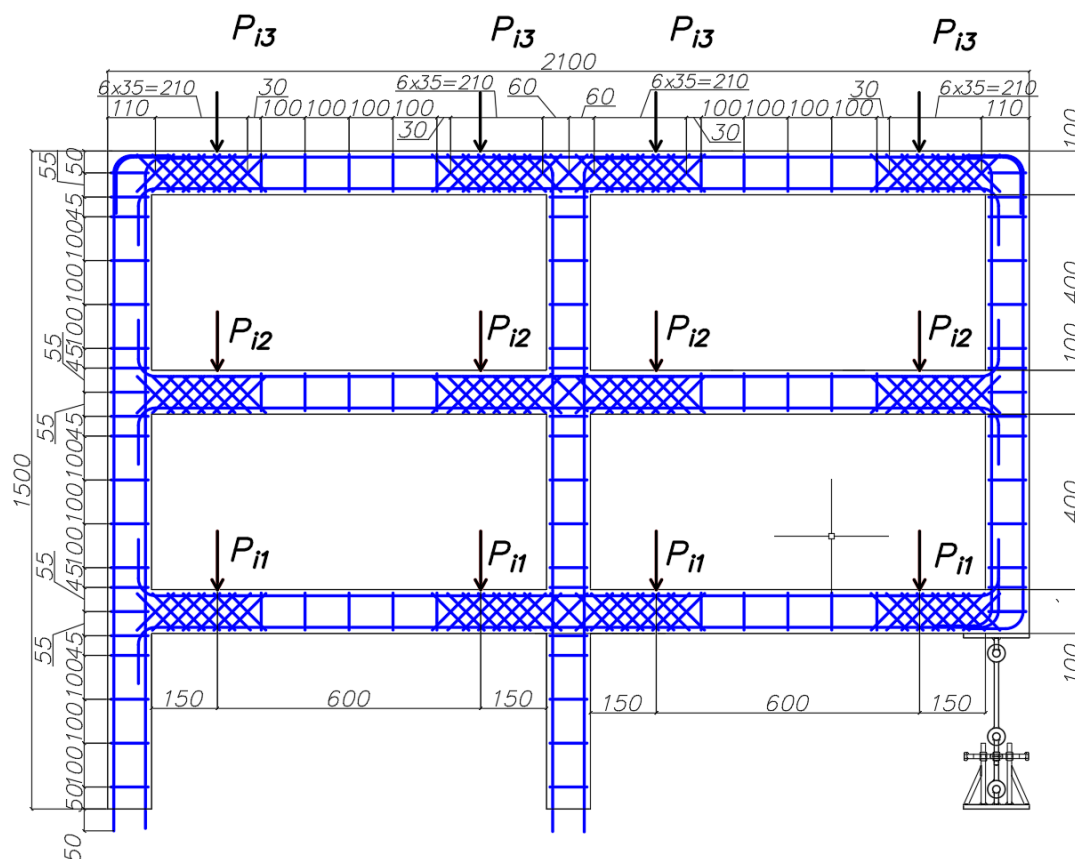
Схема армирования и нагружения опытной конструкции рамы:
